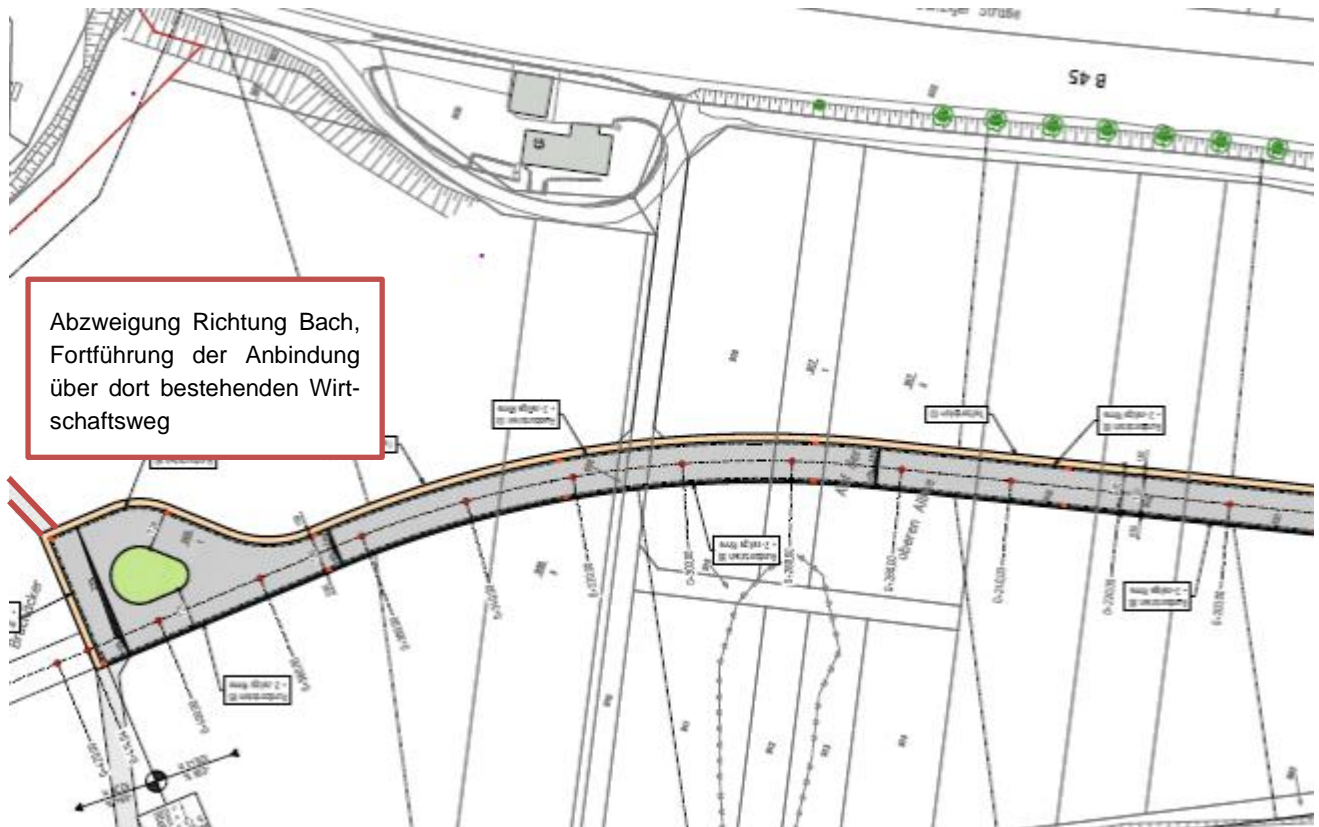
Darstellung der internen Erschließung (Stichstraße mit Wende-Kreisverkehr und Abzweigungen zum zum Fürstengrunder Bach und der Bahnlinienunterführung).
